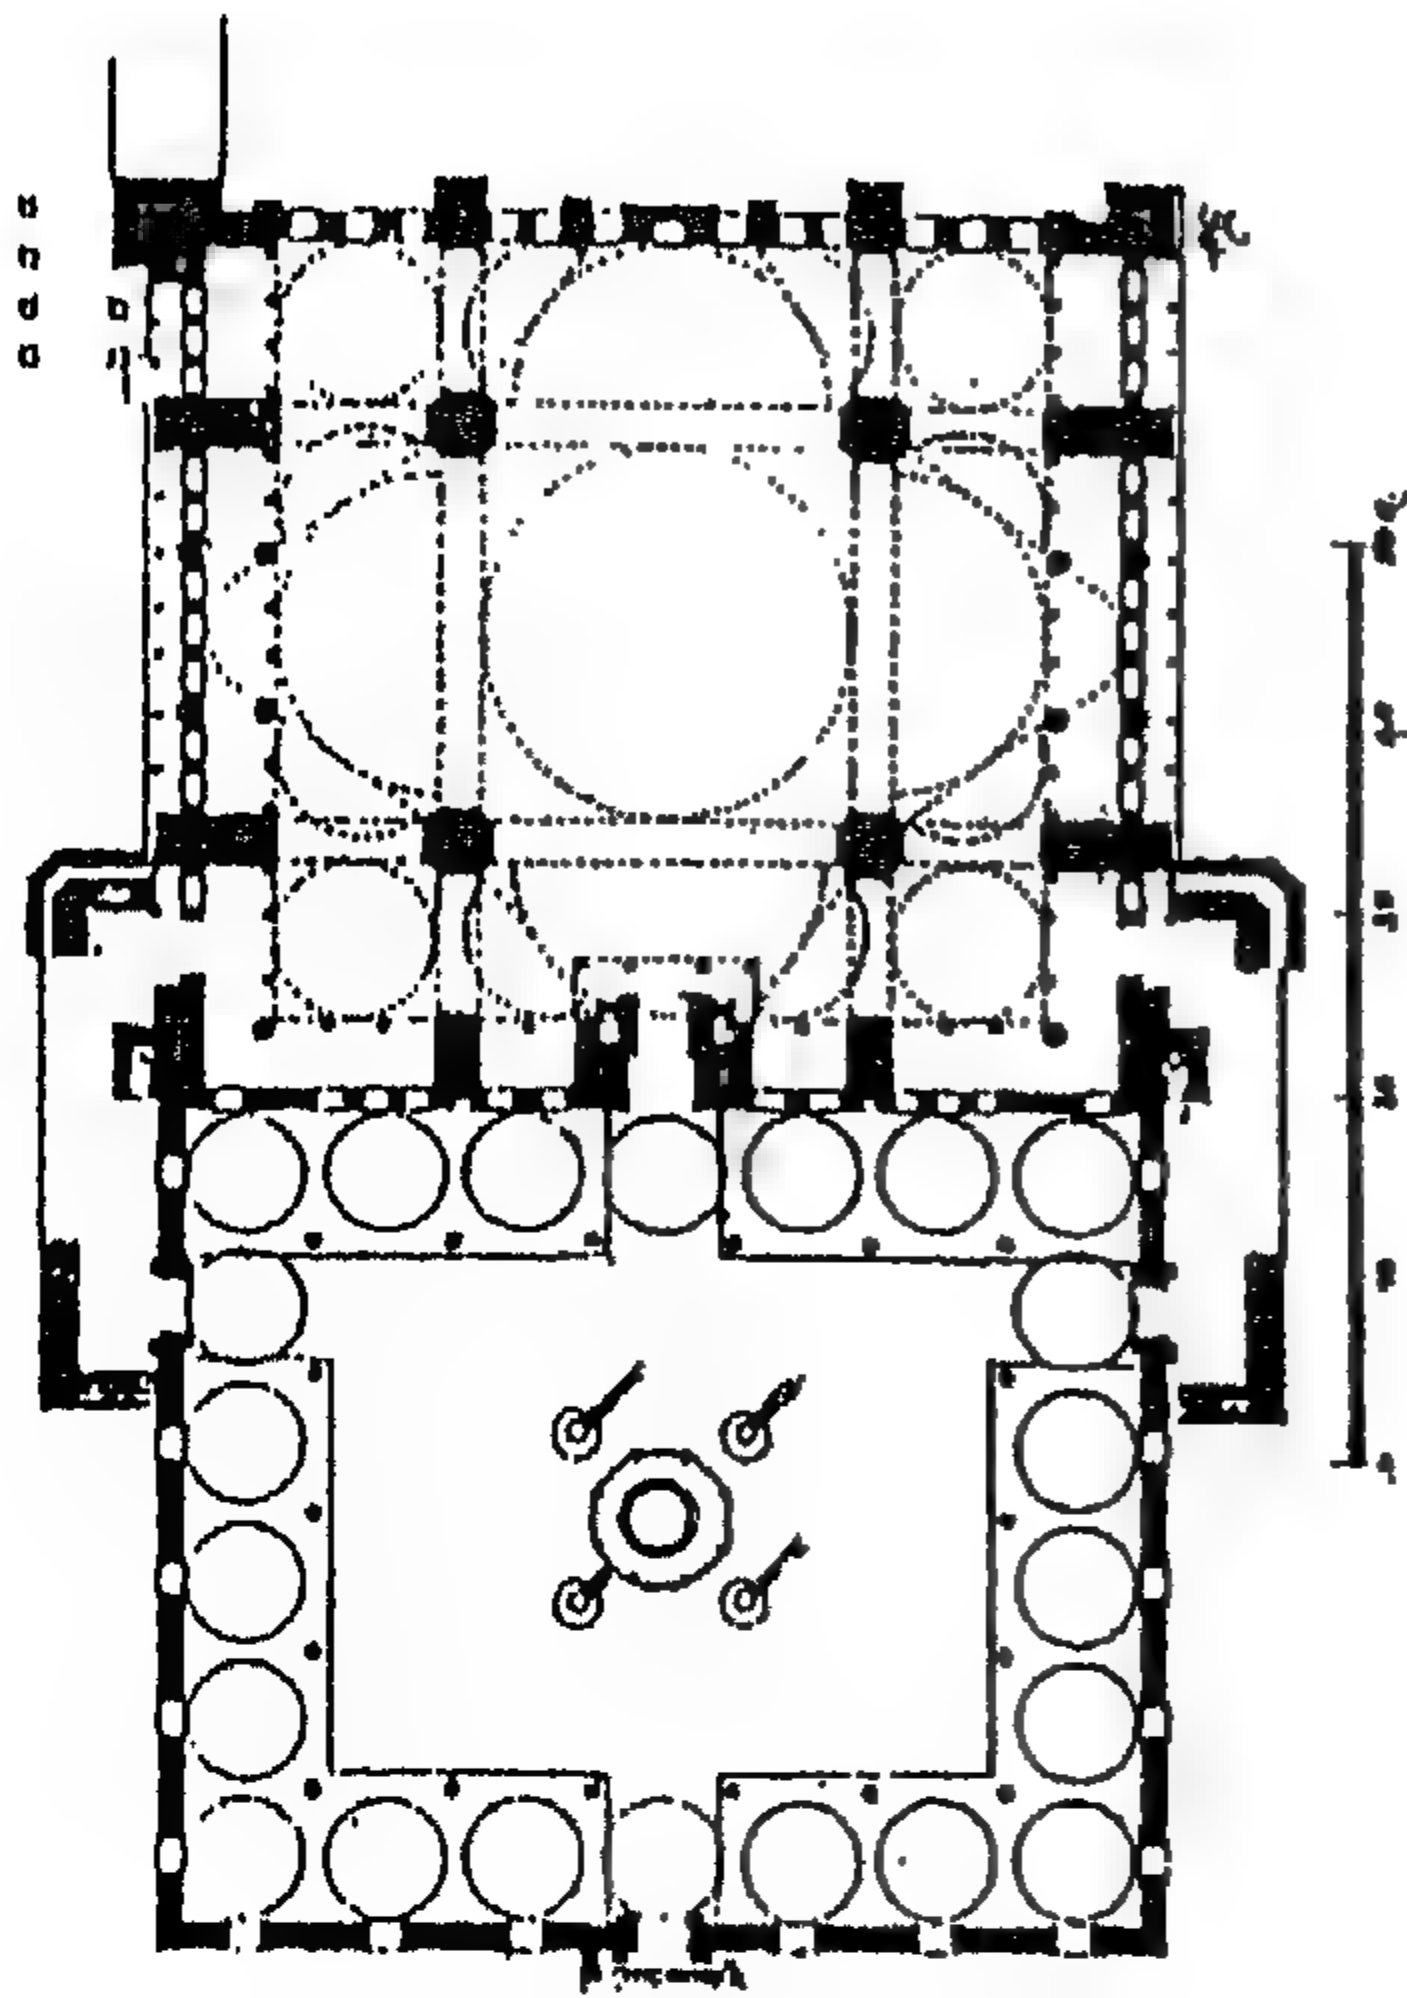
مسقط أفقي لمجمع (كلية) السلطان سليمان القانوني بإستانبول .
